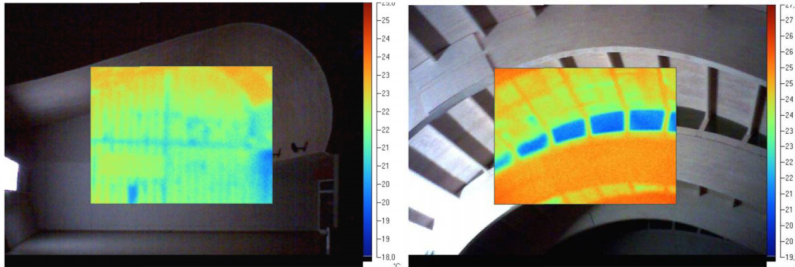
Termografía infrarroja muros fachada oriente correspondiente a oficinas cubierta.
